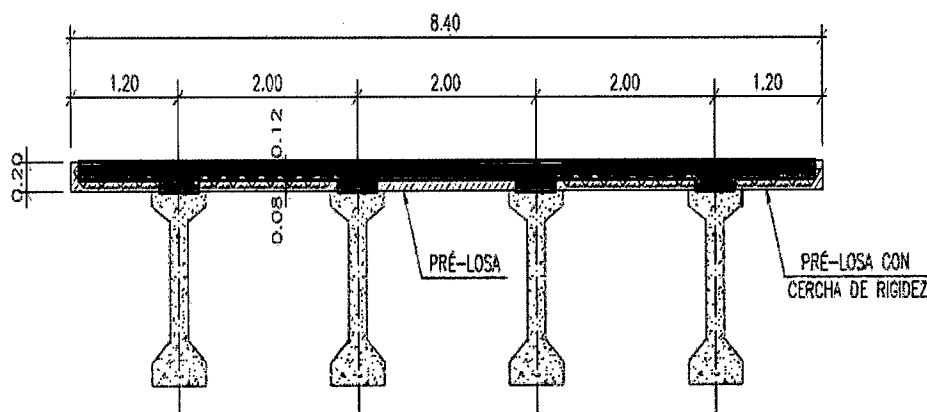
Sección típica de losa y pre-losa de viaducto
